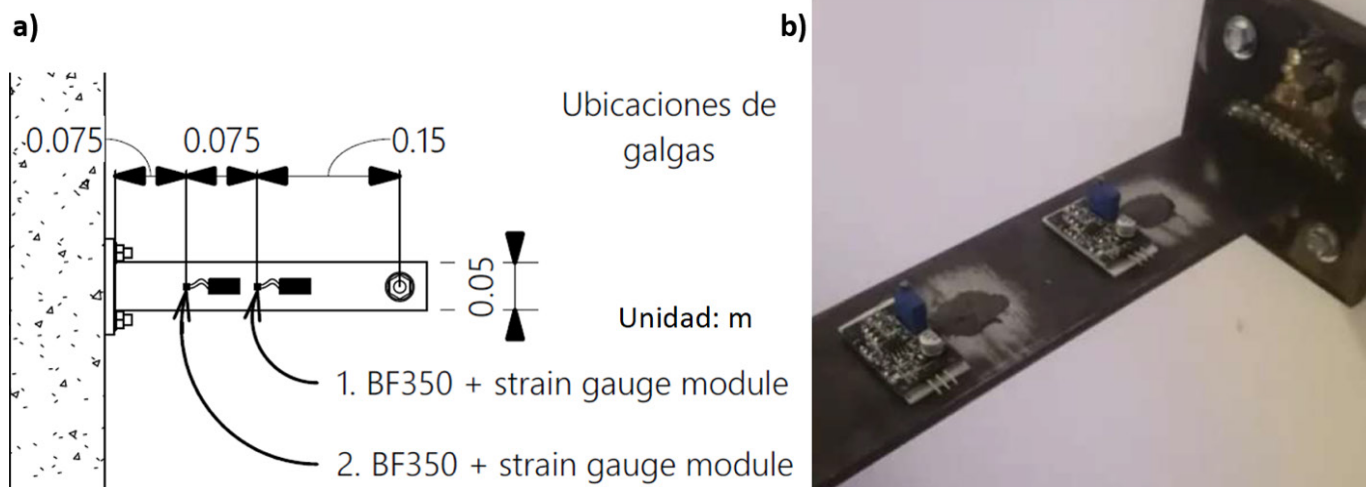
a) Ubicación de galgas extensiométricas en espécimen estructural, b) galgas extensiométricas y los módulos "Strain Gauge Module" instalados en el espécimen estructural ya empotrado.
